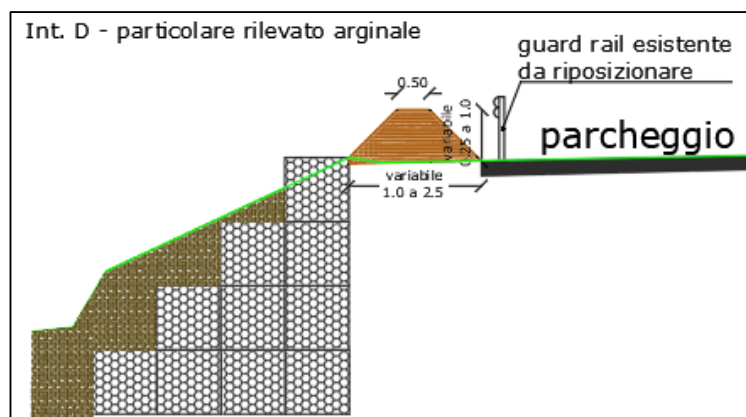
Intervento D: sezione tipo del rilevato arginale.
